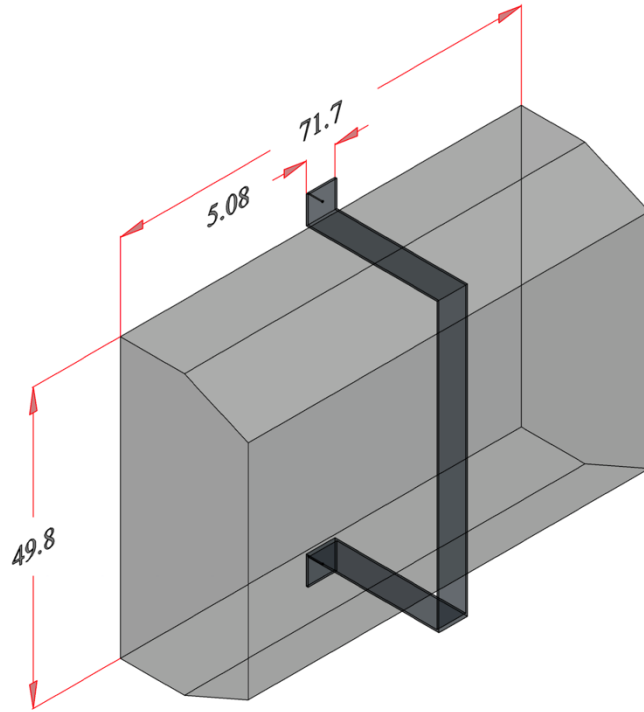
Detalle A del soporte de solera para el sistema de aire acondicionado. Dimensiones en cm.
